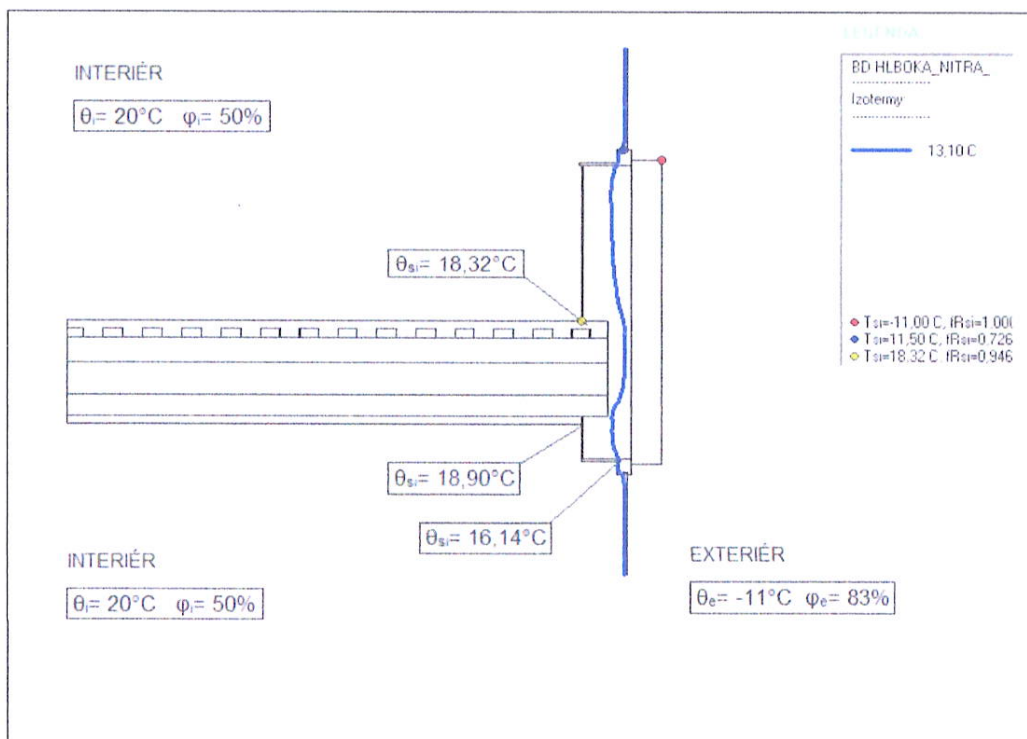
DETAIL B – DETAIL B – Styk obvodovej steny a stropnej konštrukcie
